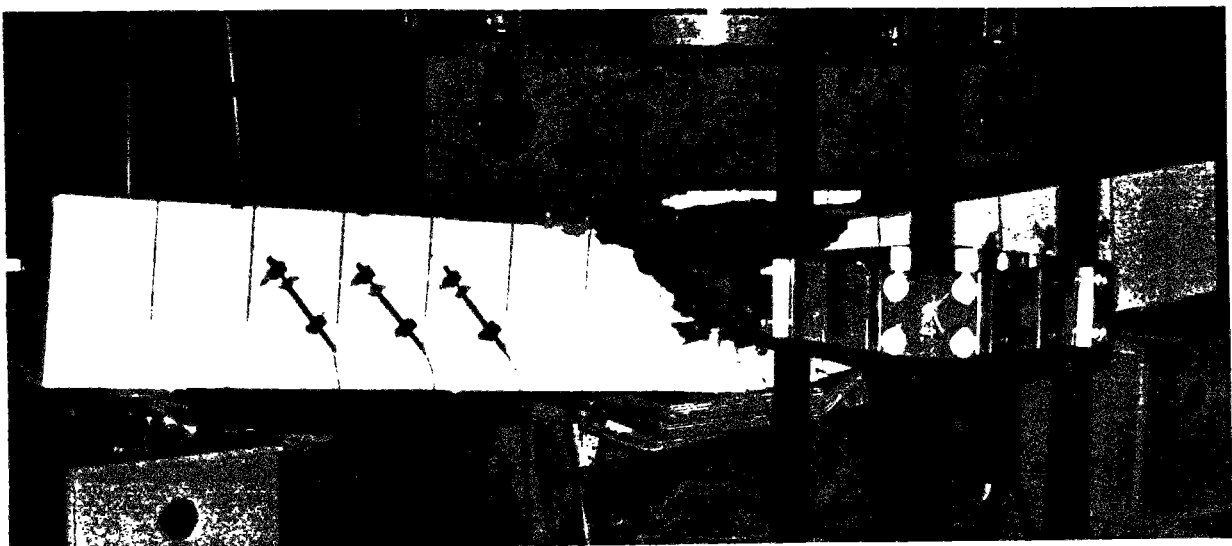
Rupture de la poutrelle BHPA2.
